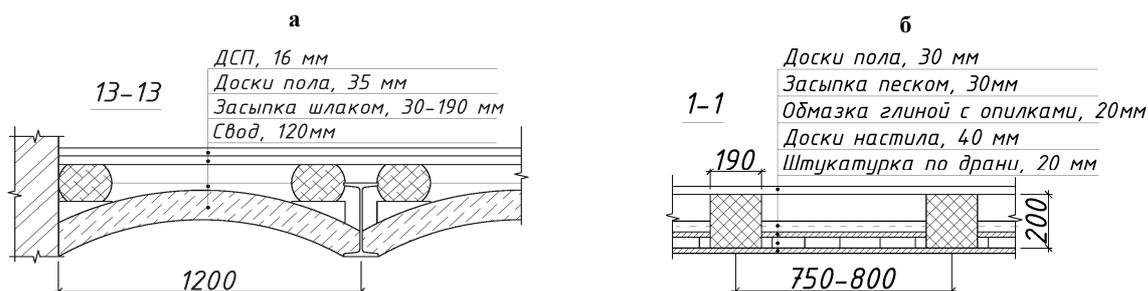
Перекрытие: над подвалом (а); междуэтажное (б)
